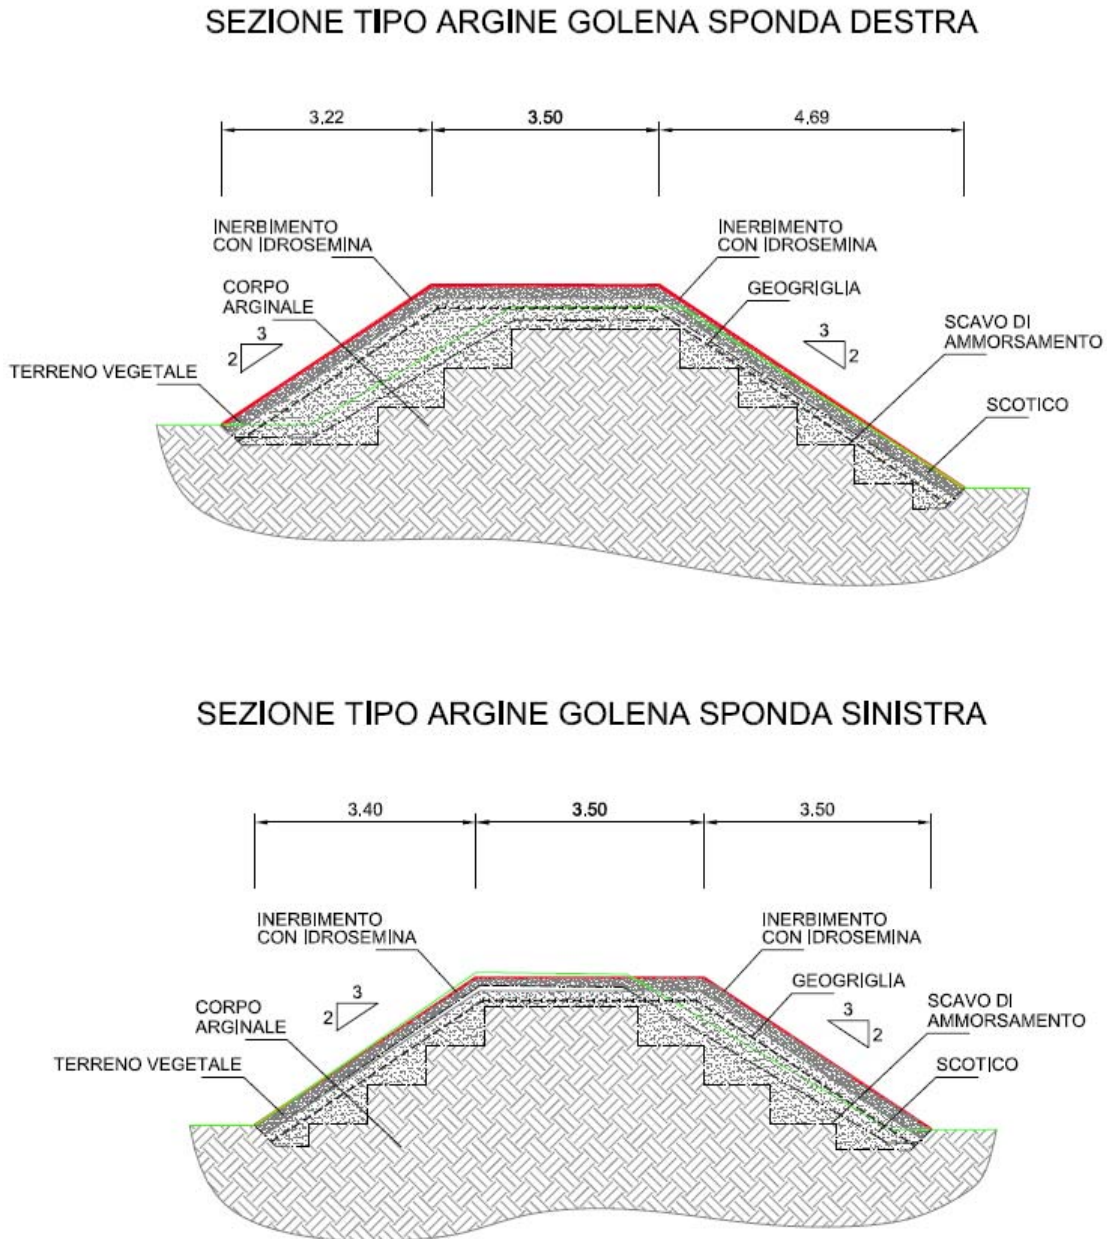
Sezioni tipo intervento LOTTO VI torrente Brana progetto preliminare [5].
